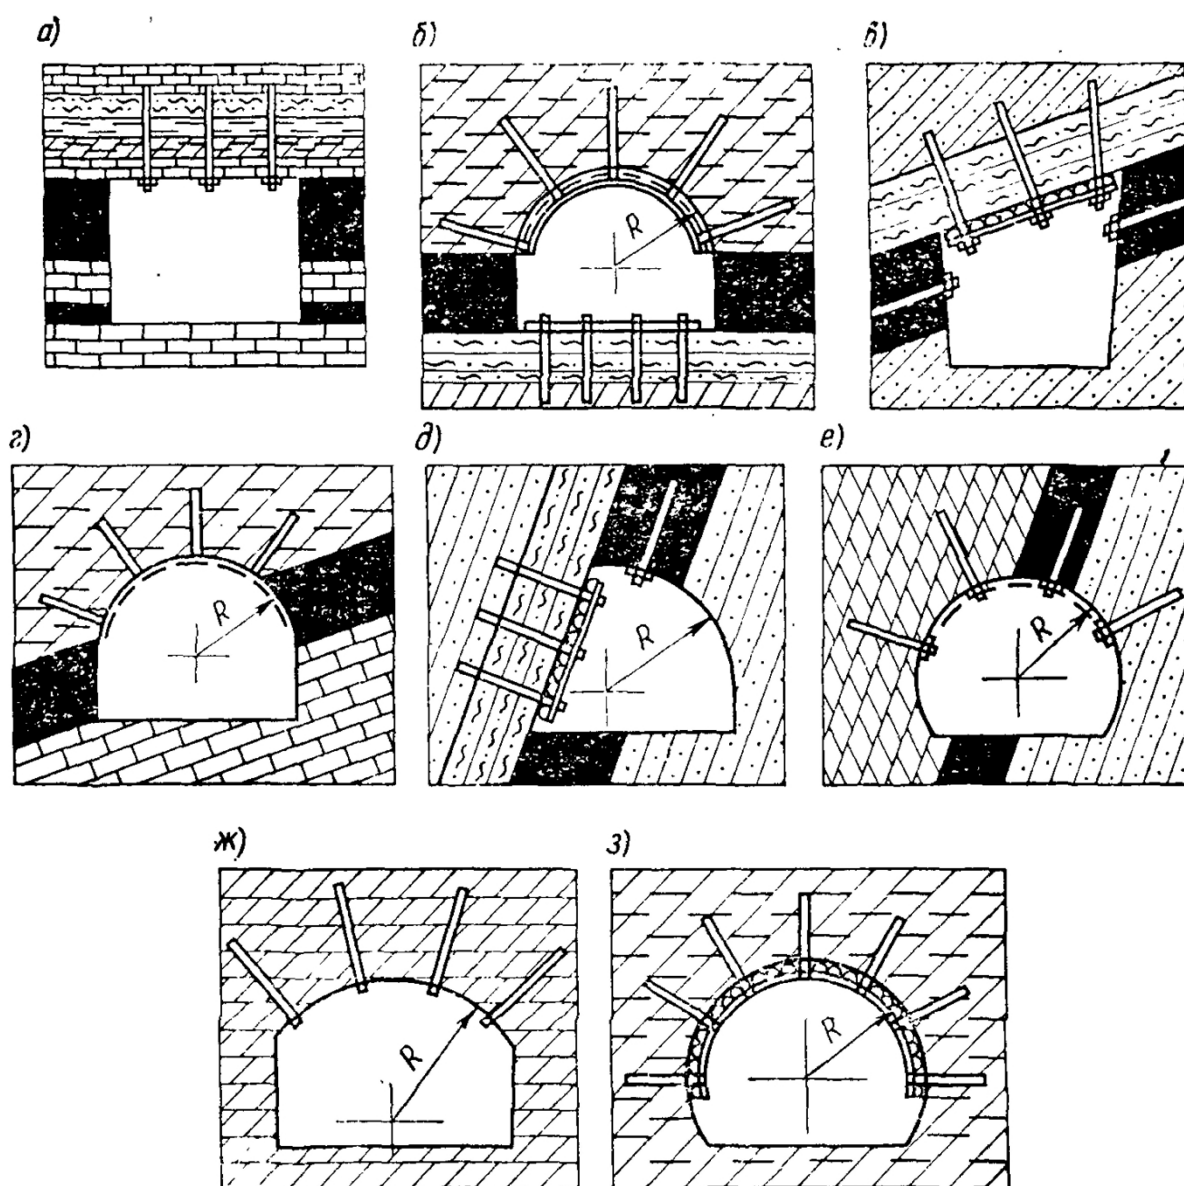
Схеми кріплення виробок анкерами: а, ж - з опорними плитками; в, д - з прямолінійними підхватами і затягуванням; б, г, е, з - з арковими сталевими підхватами
